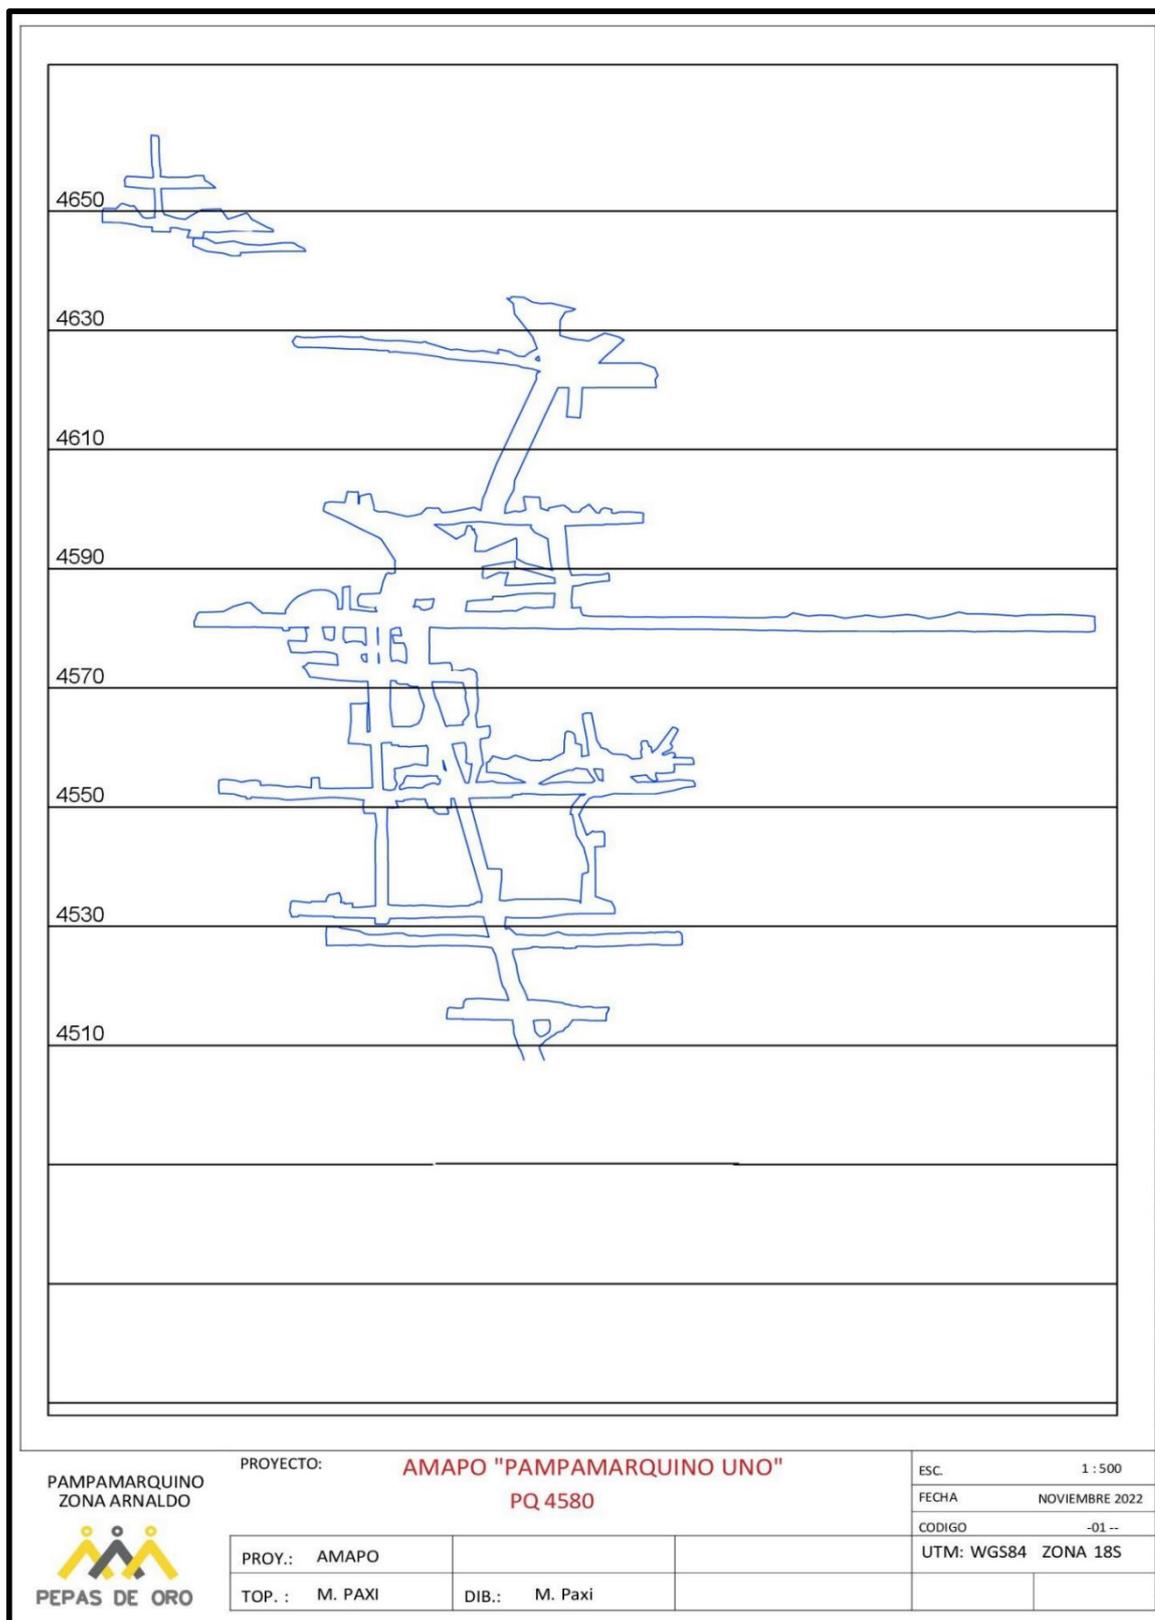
Plano longitudinal de labores U.O.Pampamarquino
